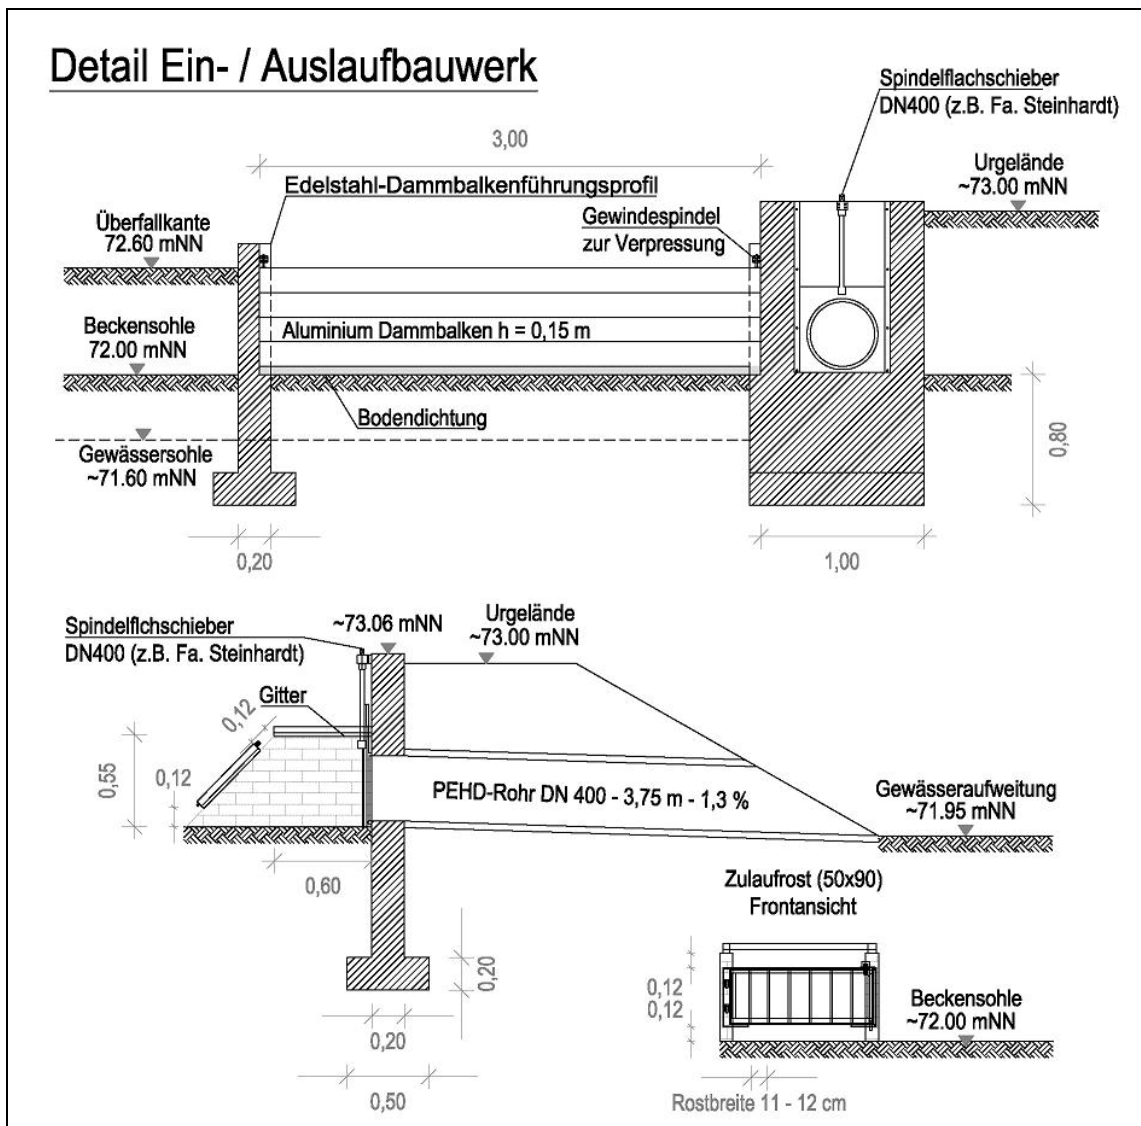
Prinzipskizze der geplanten Dammbalkensperre mit Auslaufbauwerk
